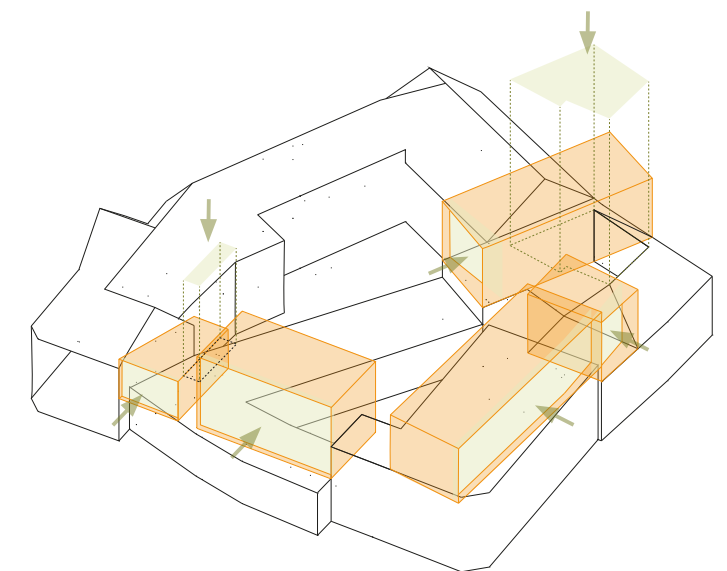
Baukörperkonzept: versetzte Fassaden, Ausbildung Fugen
